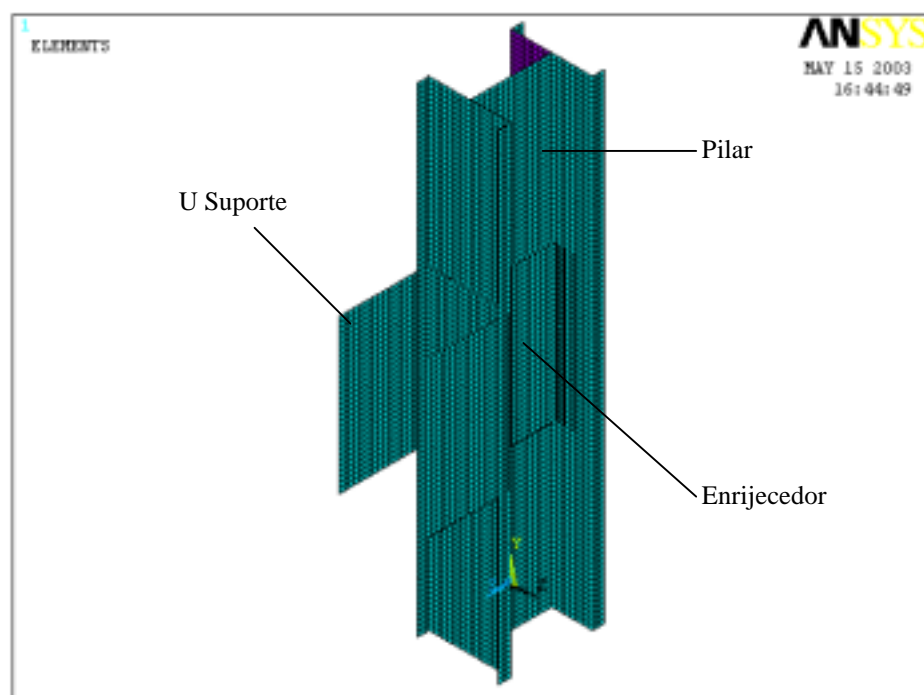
Modelagem da configuração da ligação viga-pilar proposta.
